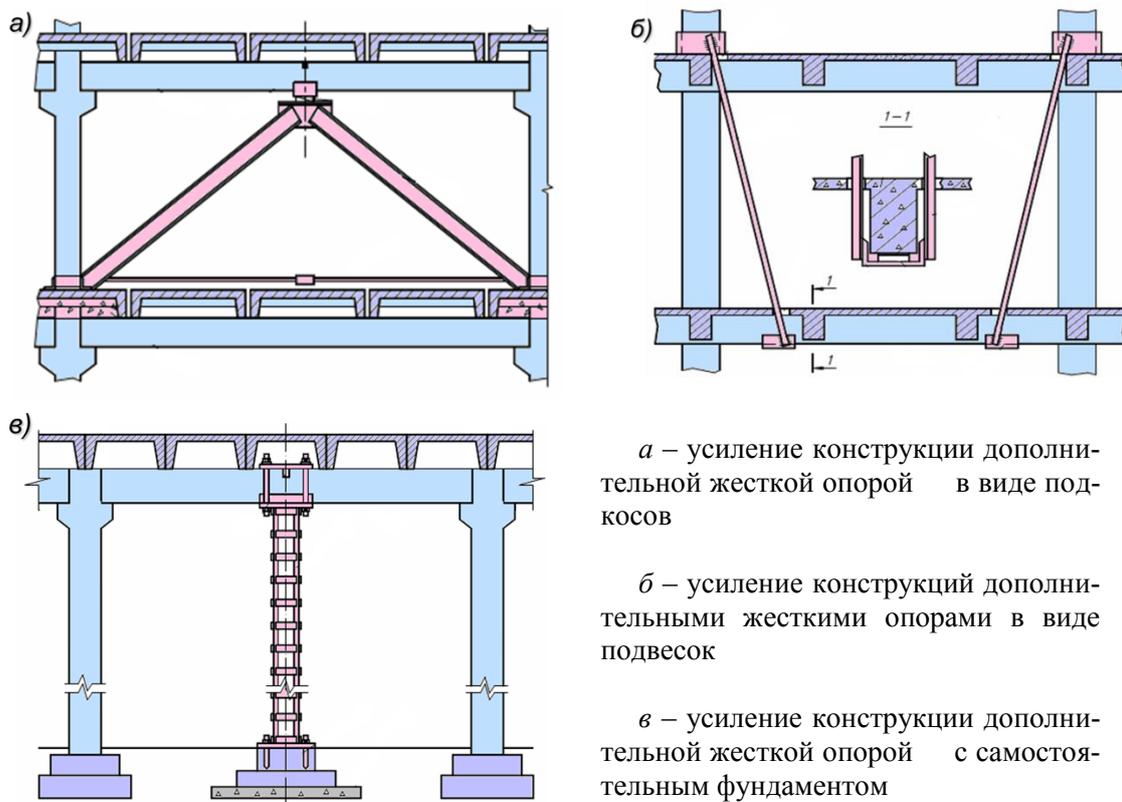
Усиление железобетонных конструкций дополнительными жесткими опорами
